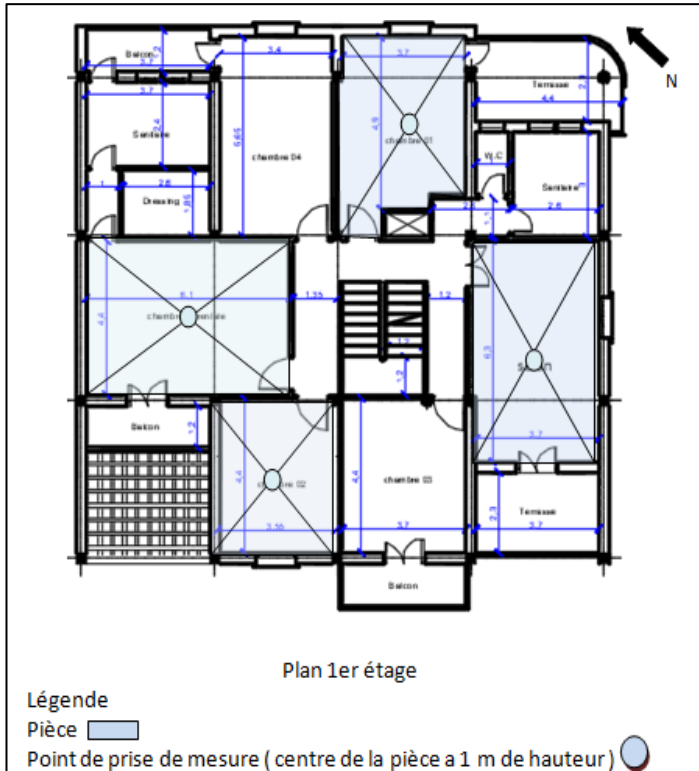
plan 1er étage ech 01 (source : auteur)
